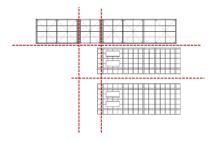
(j) Denah Pembalokan Lantai 8
